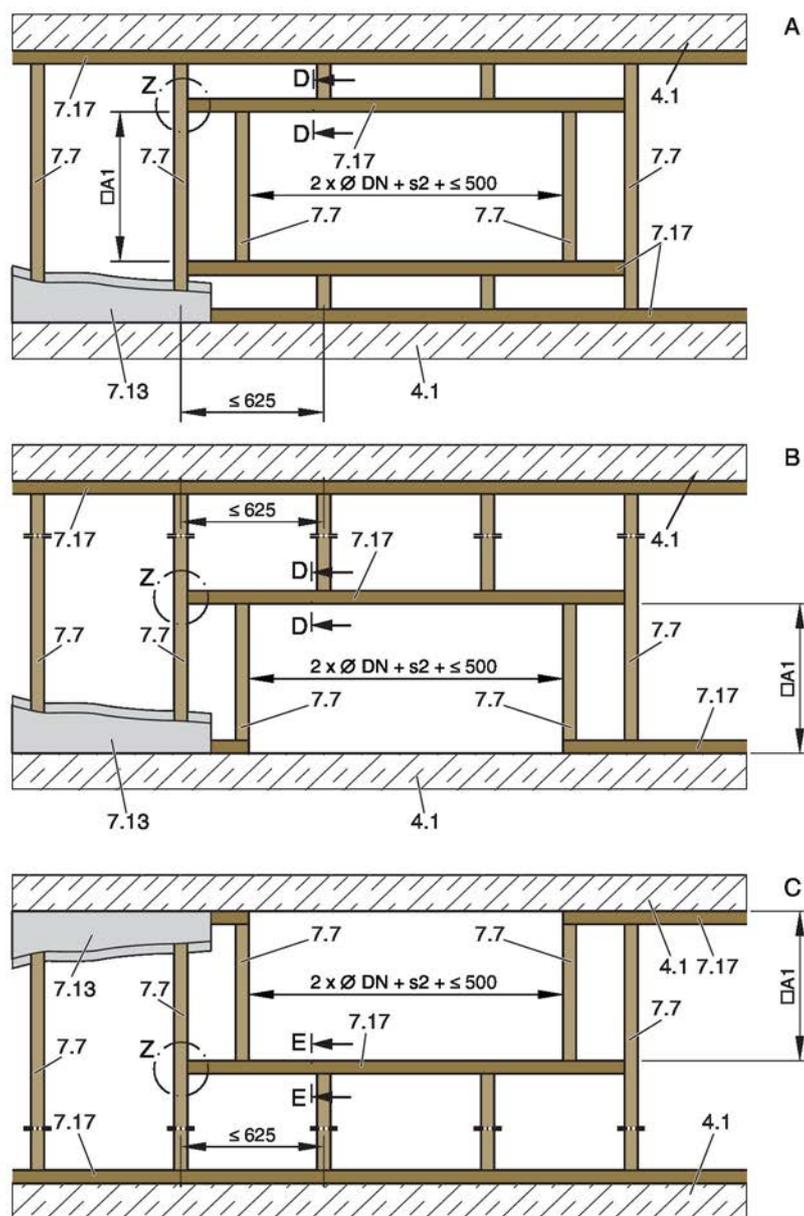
Parede divisória leve com estrutura de apoio de madeira e revestimento em ambos os lados, flange a flange, dimensões nominais: Ø largura nominal 315 – 400
